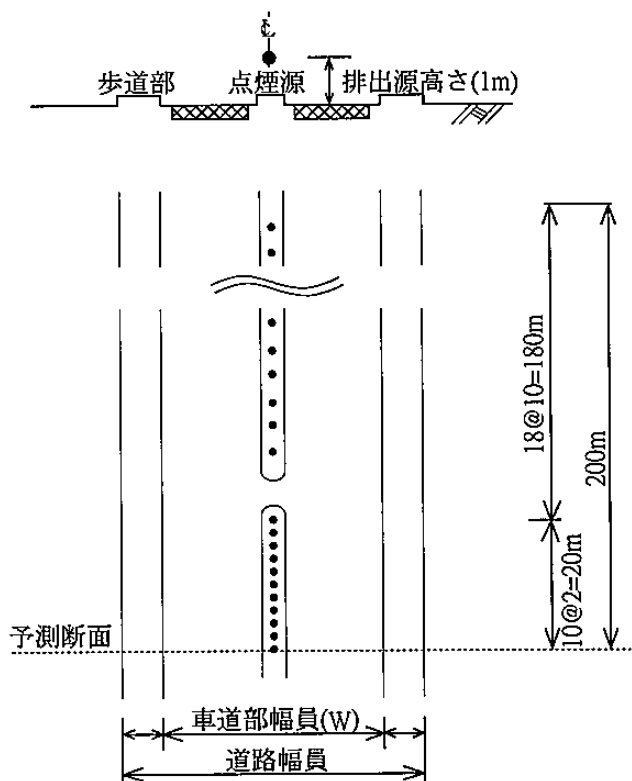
排出源の位置図 (断面及び平面図)
